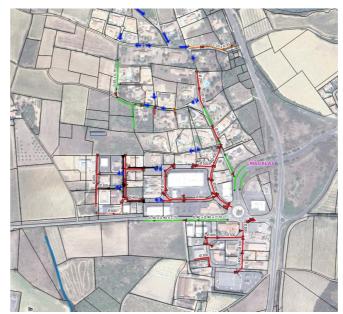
Extrait du plan des réseaux pluviaux - secteur de la ZAE l'Audacieuce
